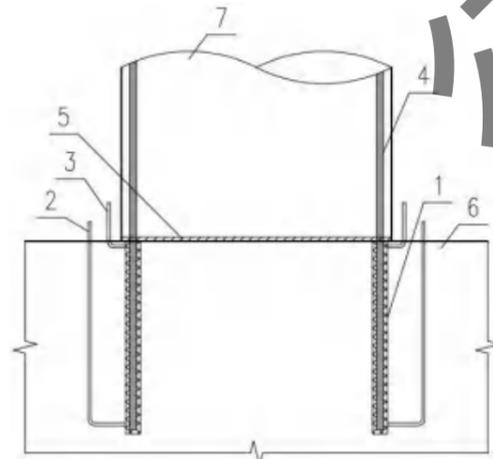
墩柱与承台钢筋灌浆波纹管连接典型构造示意图
